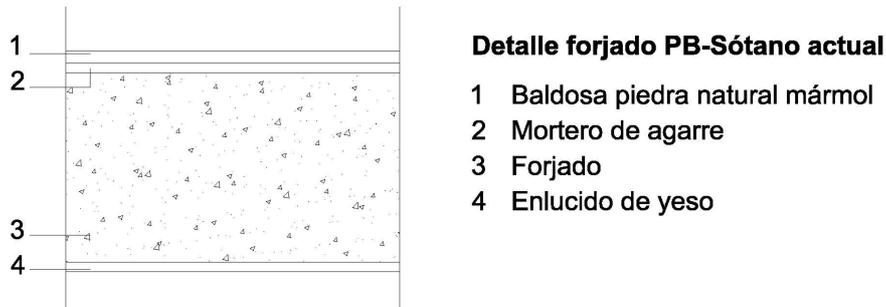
Detalle forjado entre planta baja y sótano actual. Fuente: Elaboración propia
